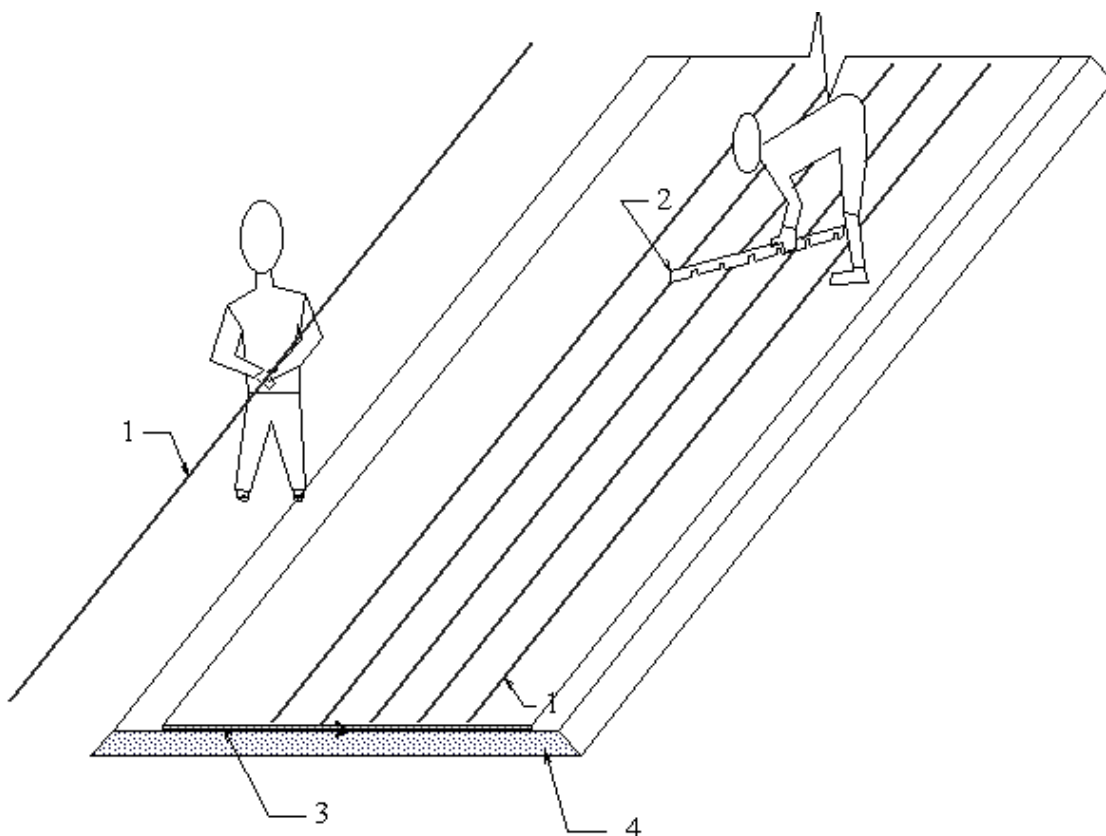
Укладка продольных арматурных стержней: 1 – арматурный стержень; 2 – шаблон для выравнивания; 3 – горизонтальная гидроизоляция; 4 – песчаная подготовка
